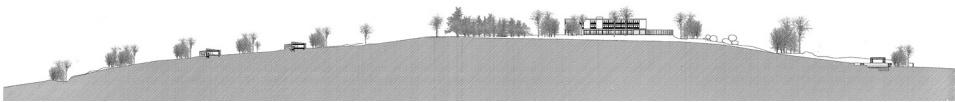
Implantação e perfil geral - Segunda proposta de intervenção.
